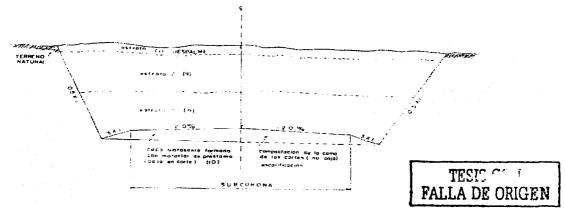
Sección transversal típica conteniendo los elementos del grupo B
